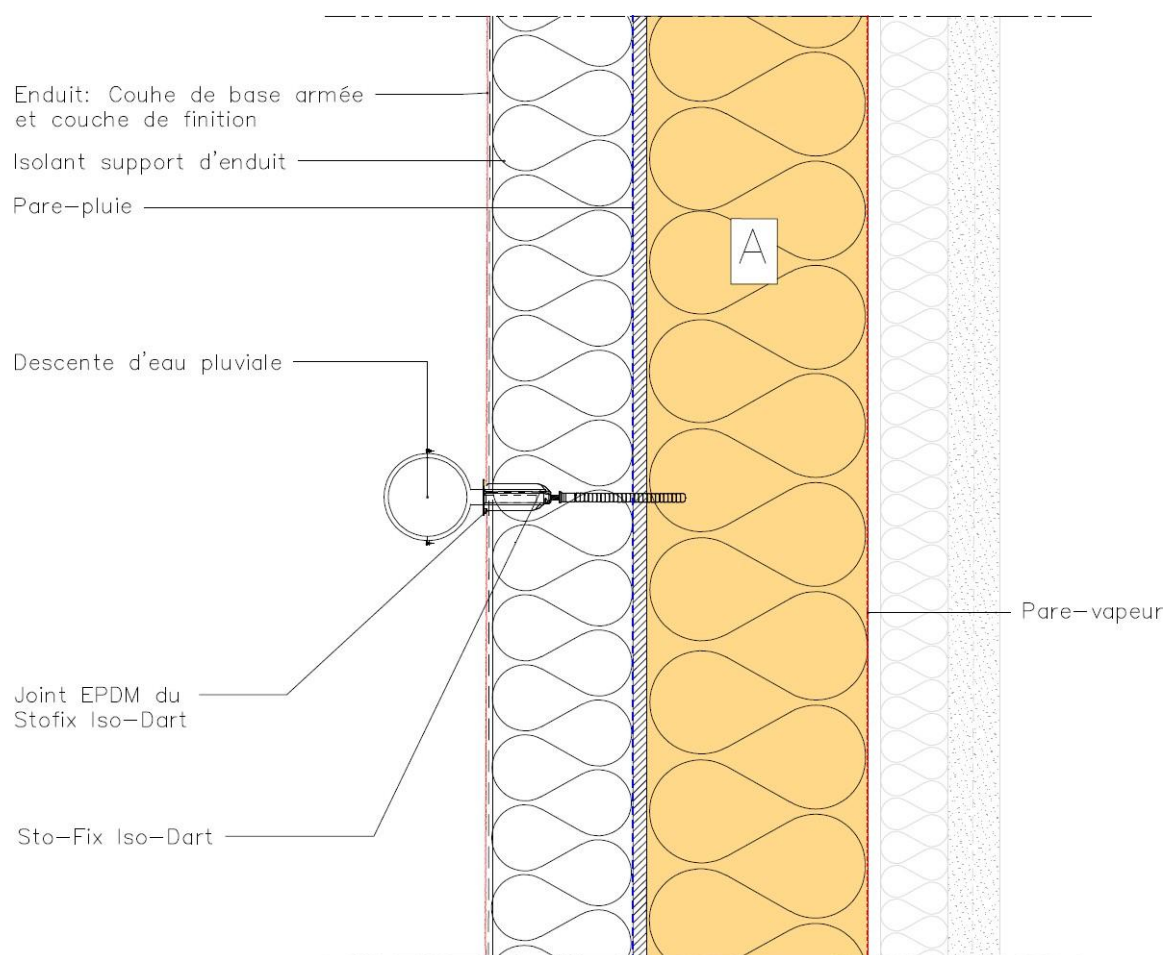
Fixation de descente d'eau pluviale - Coupe Horizontale
